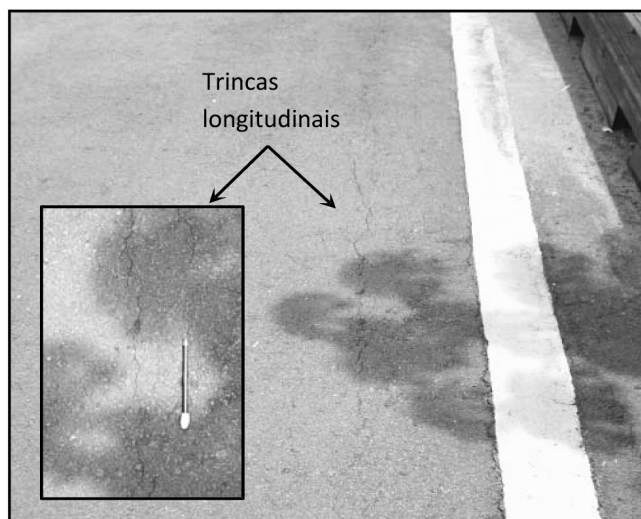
Trincas longitudinais no revestimento da ponte multicelular protendida com vigas compostas com alma de compensado
